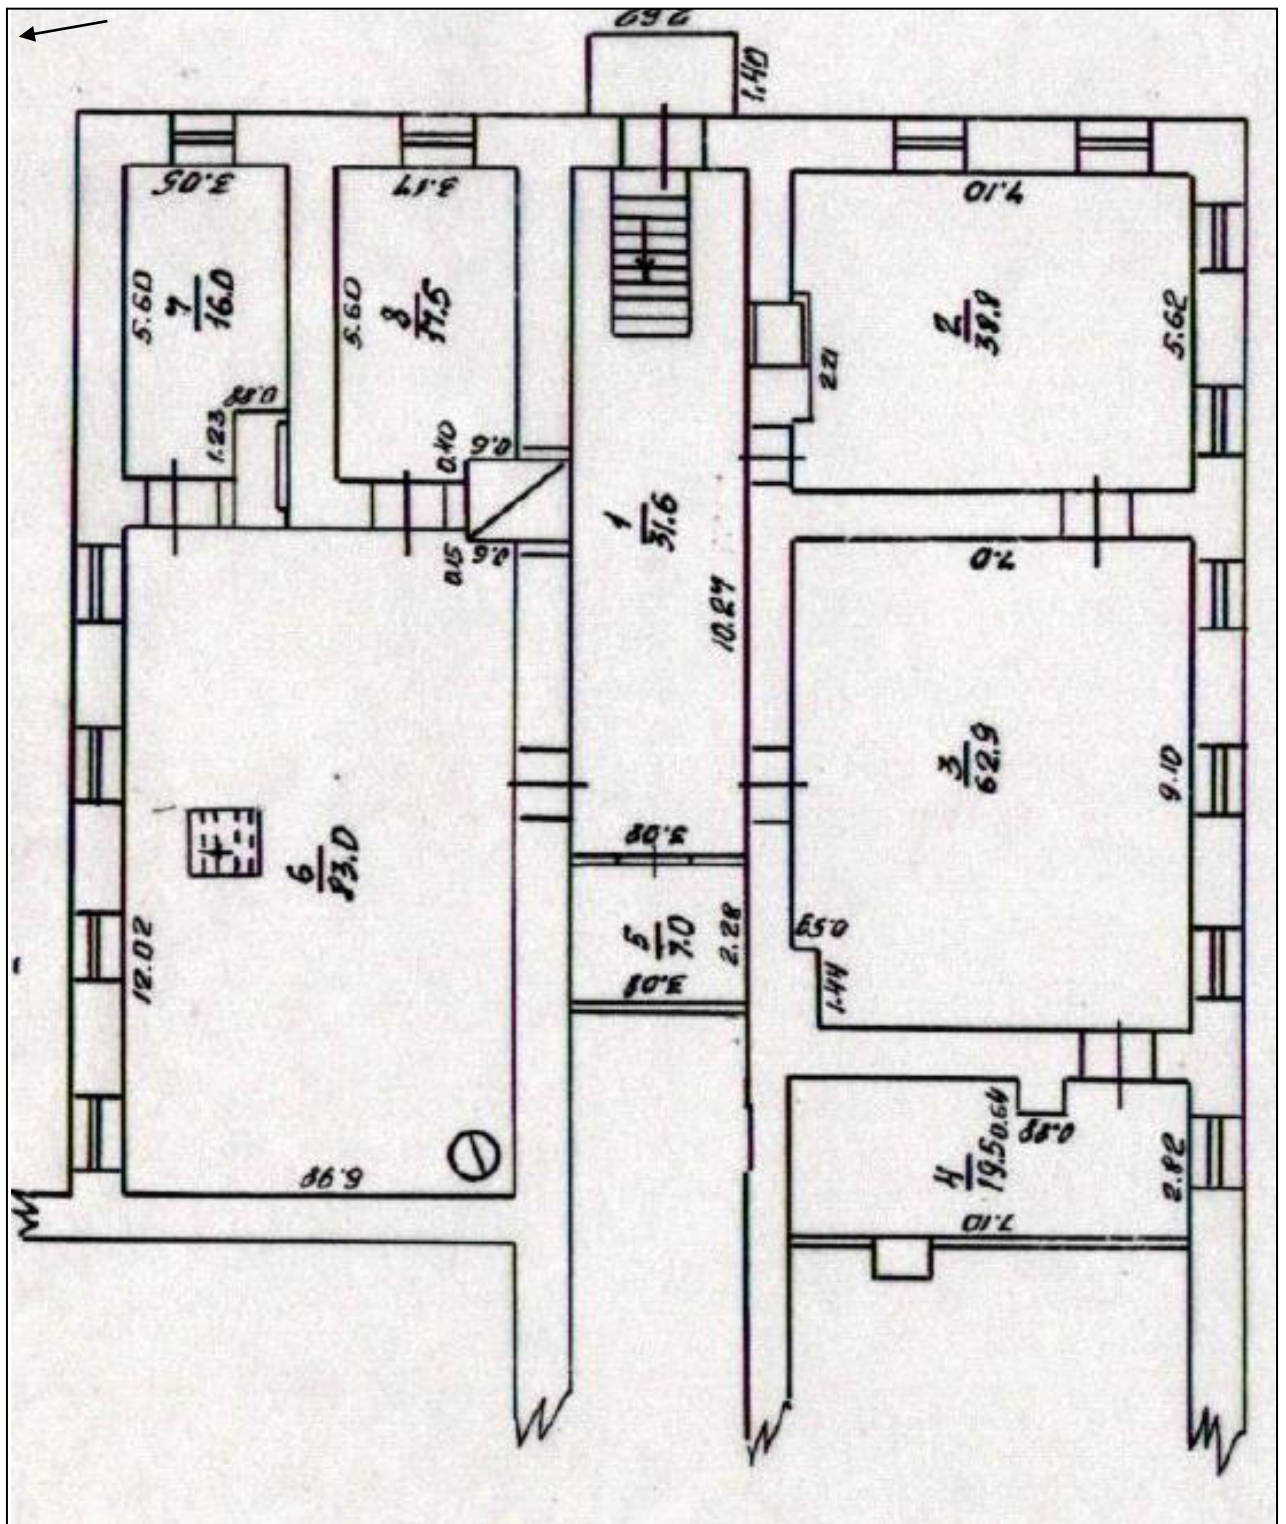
Фрагмент плана первого этажа. 2002 г.
